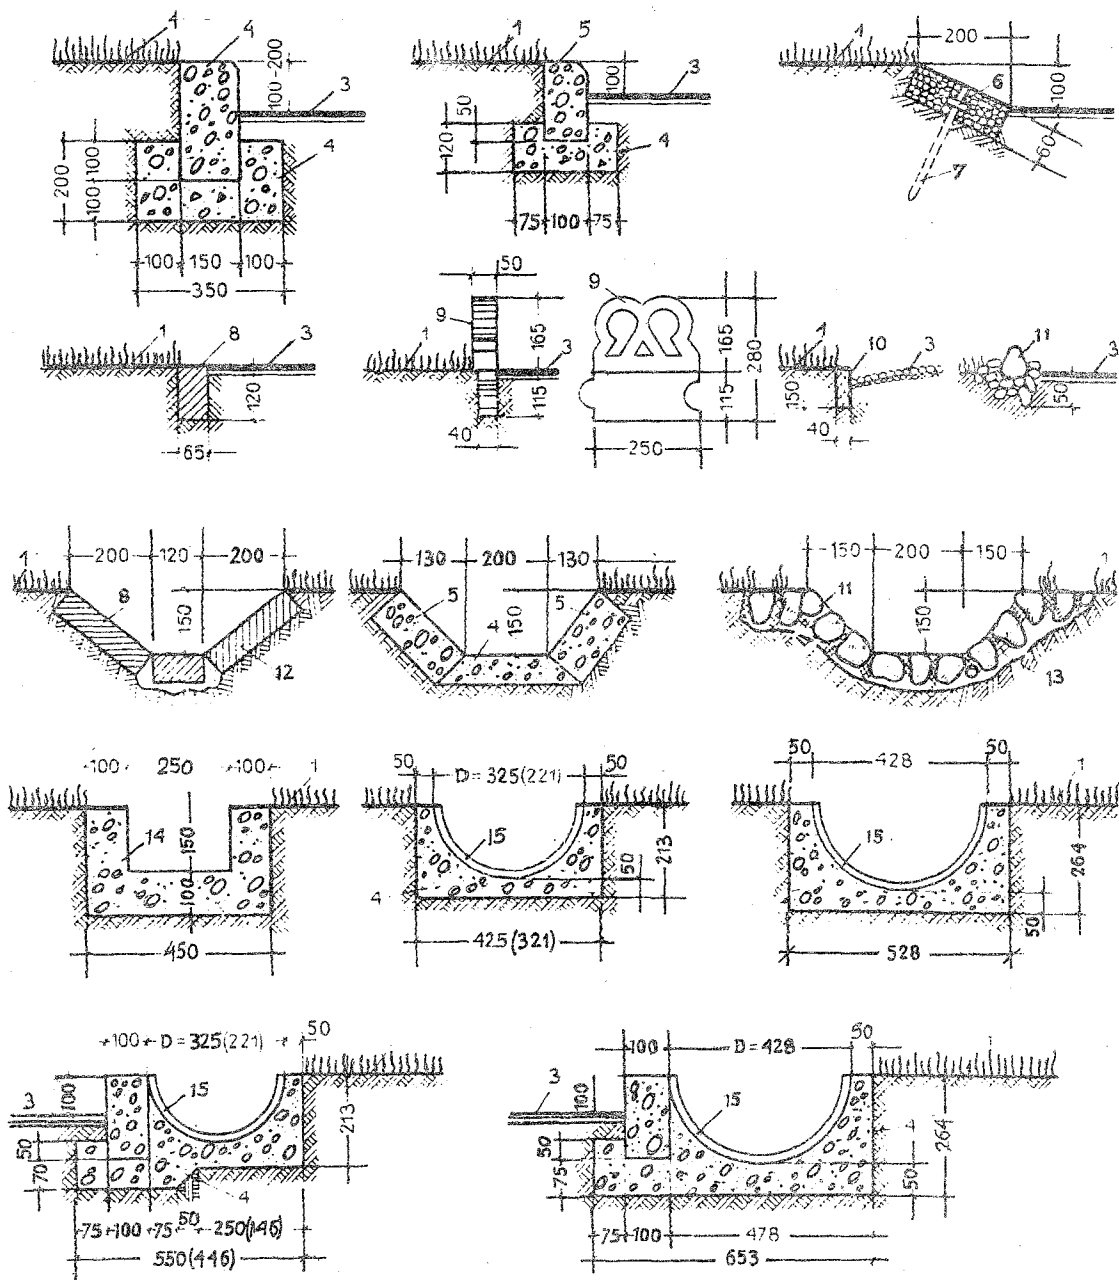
Конструкции дорожных одежд улиц, проездов, тротуаров и газонов в узлах их сопряжений: 1 - газон; 2 - бетонный или гранитный бортовой камень 150x200 мм; 3 - покрытие дорожки или площадки; 4 - бетон марки 100 на кирпичном щебне; 5 - бетонный бортовой камень сечением 100x200 мм; 6 - дерновая лента; 7 - деревянная доска; 8 - красный строительный кирпич; 9 - керамическое ограждение; 10 - доска на ребро; 11 - булыжный камень и галька; 12 - цементный раствор марки 50; 13 - мягкая глина; 14 - бетон марки 200; 15 - асбоцементная труба, распиленная пополам
